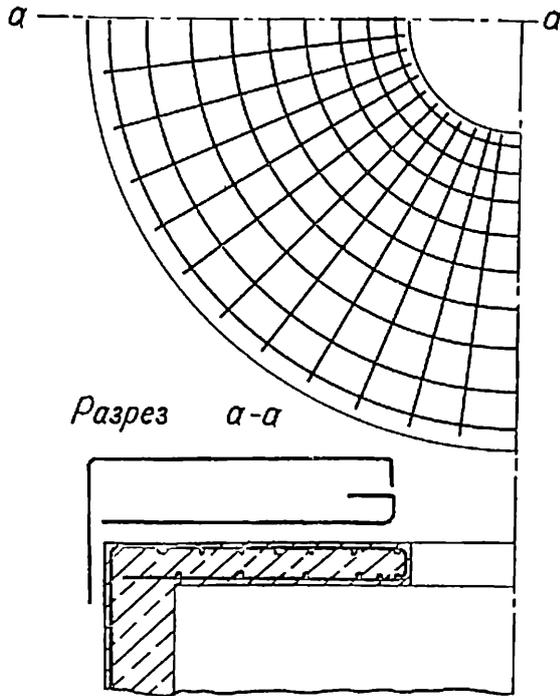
44 Гиперболическая эпюра материала при радиальном армировании
